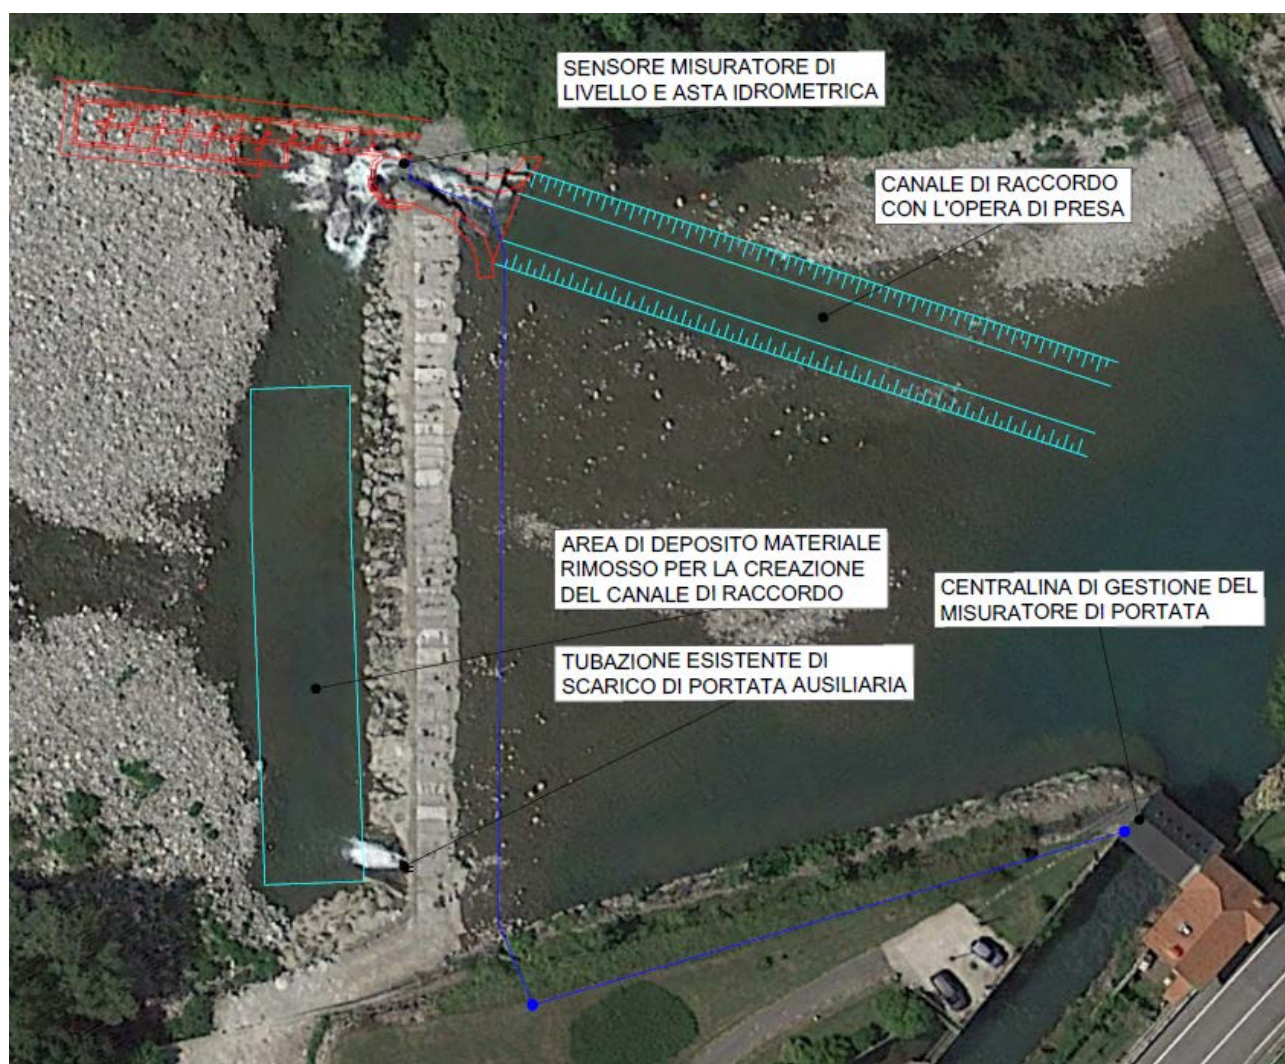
planimetria generale degli interventi in progetto, estratto tavola C.2.4
